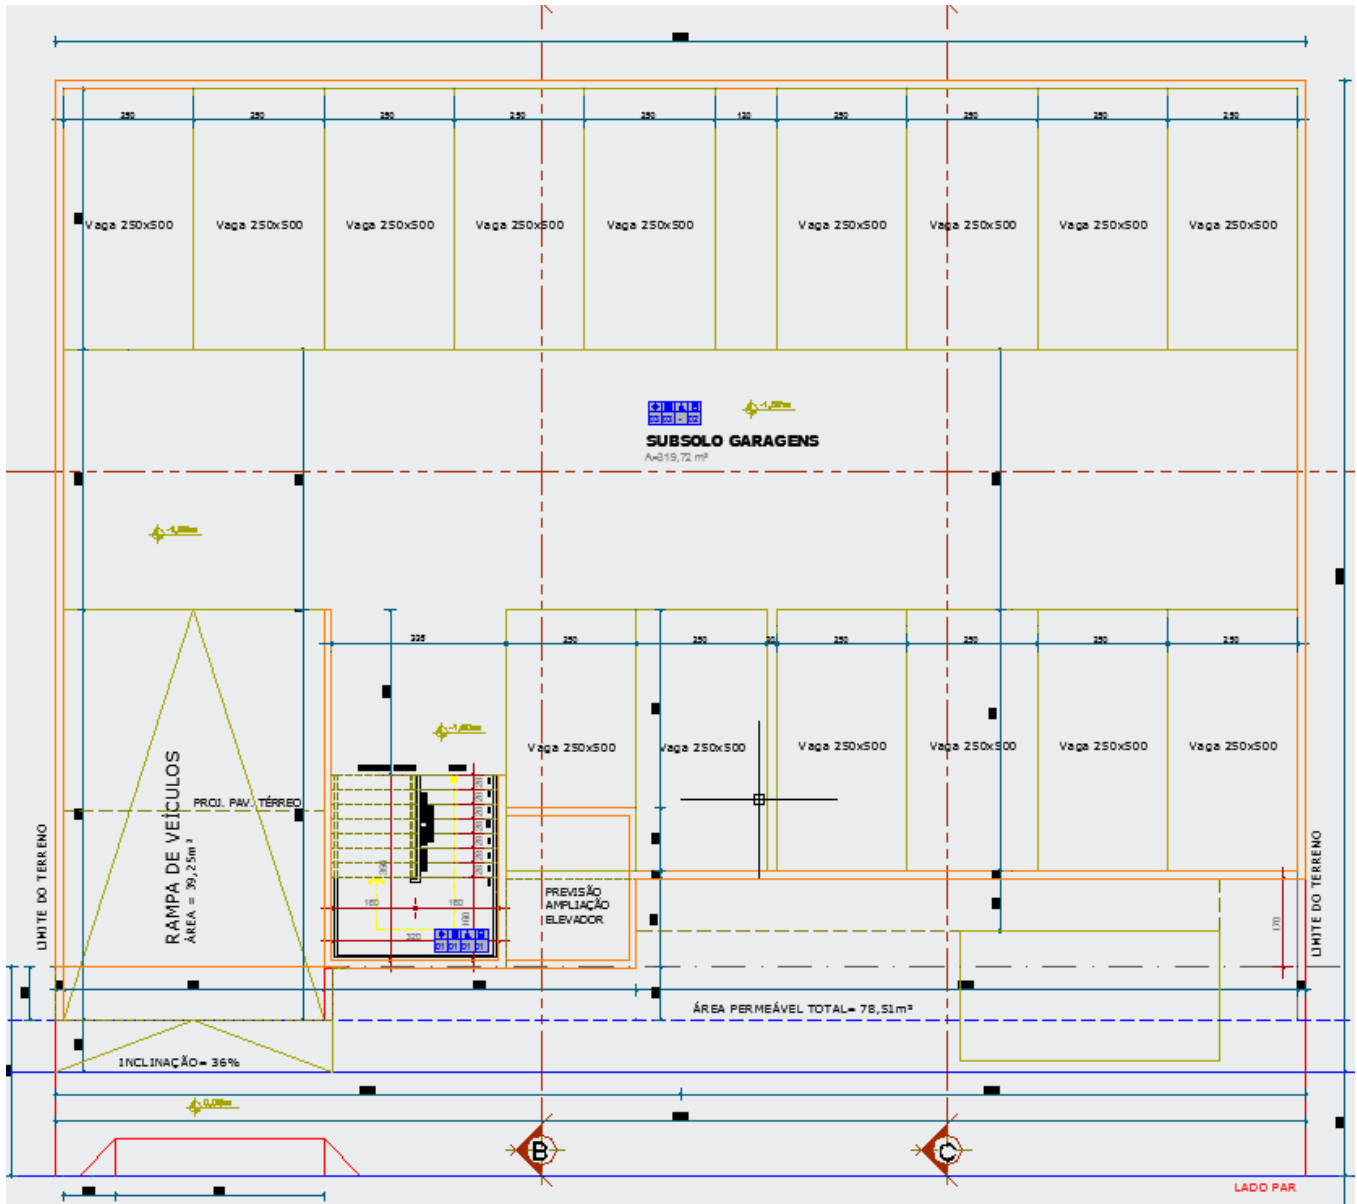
Planta baixa das vagas de garagem, conforme projeto aprovado pela prefeitura de Balneário Camboriú.
